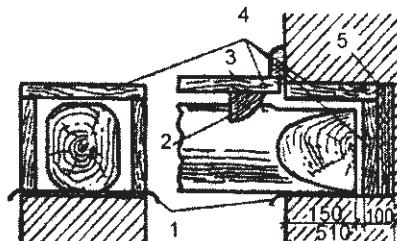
Заделка концов деревянных балок междуэтажных перекрытий в стену толщиной в 2 кирпича
